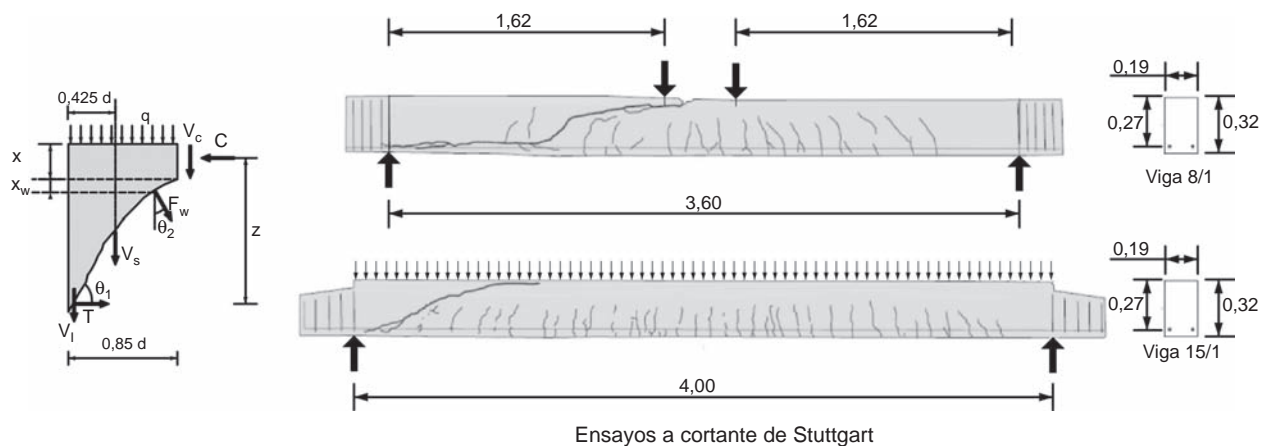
Viga sometida a carga repartida. Esfuerzos y fisuración.
